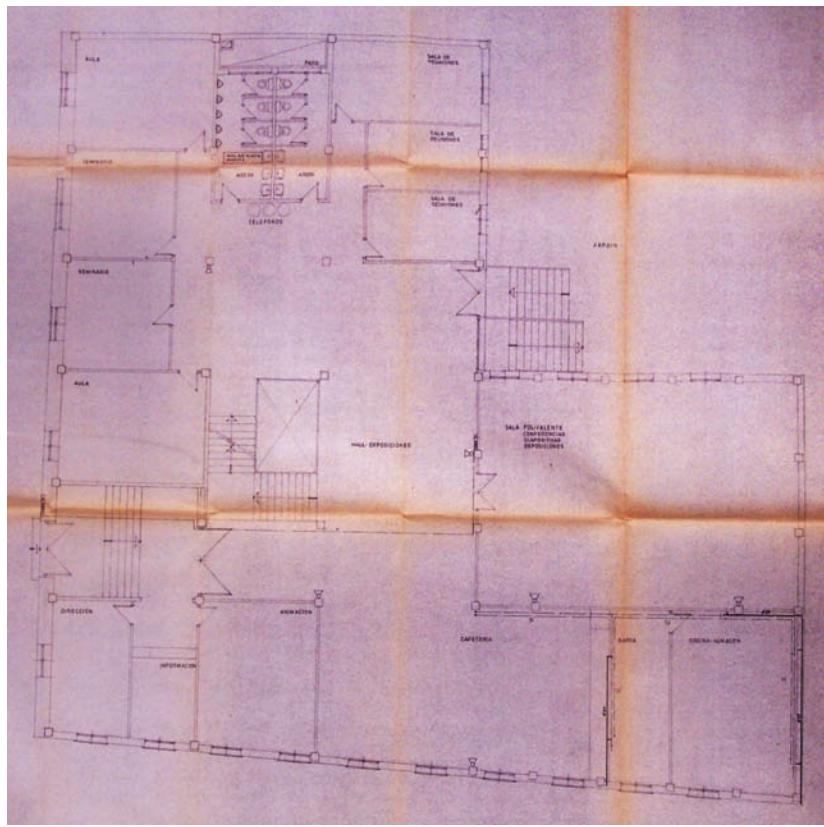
Plano de la planta baja de la Casa de la Cultura. AMA legajo 1464-1467.
